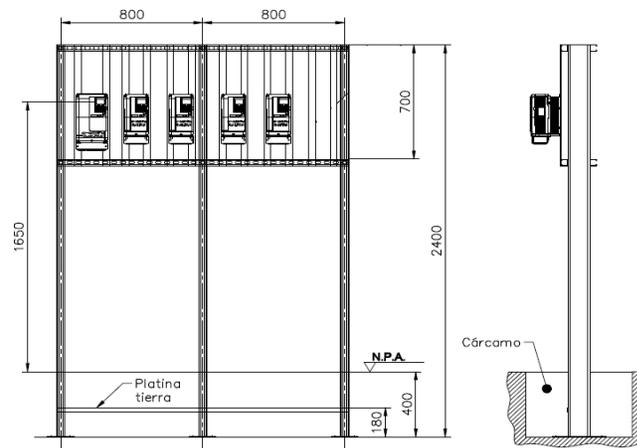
Layout Rack de Variadores (Quintero, 2013).
